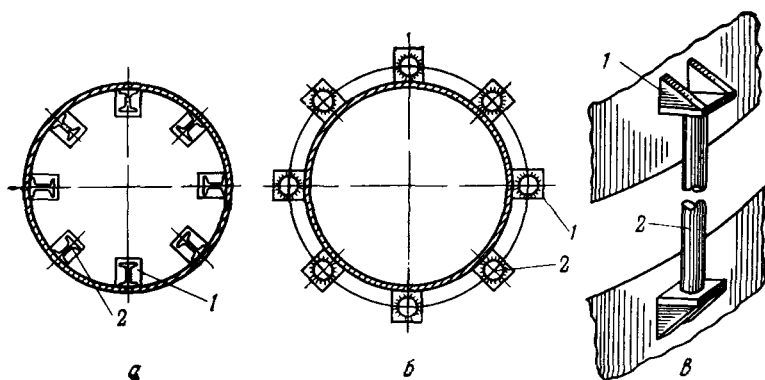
Усиление колонны в местах вырезаемых поясов:
